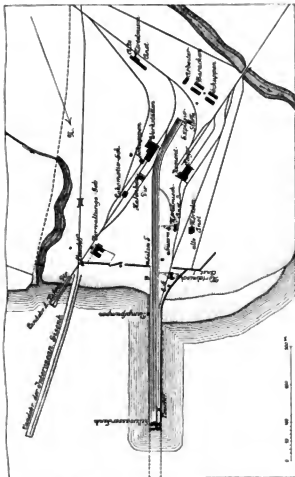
Lageplan der Arbeitsstelle für den Hafenanbau.
